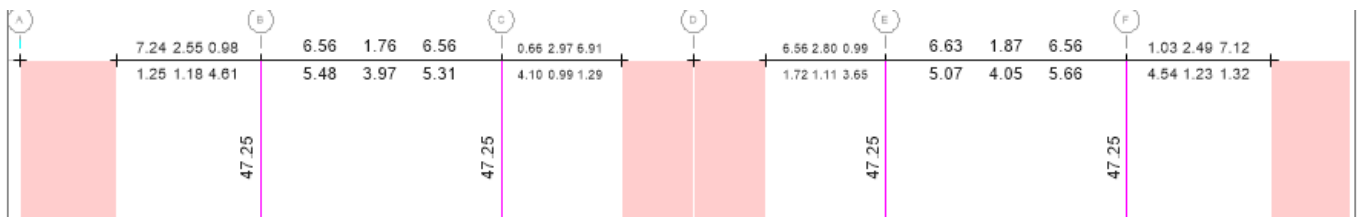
Acero Requerido por momentos en Vigas 8° Piso
